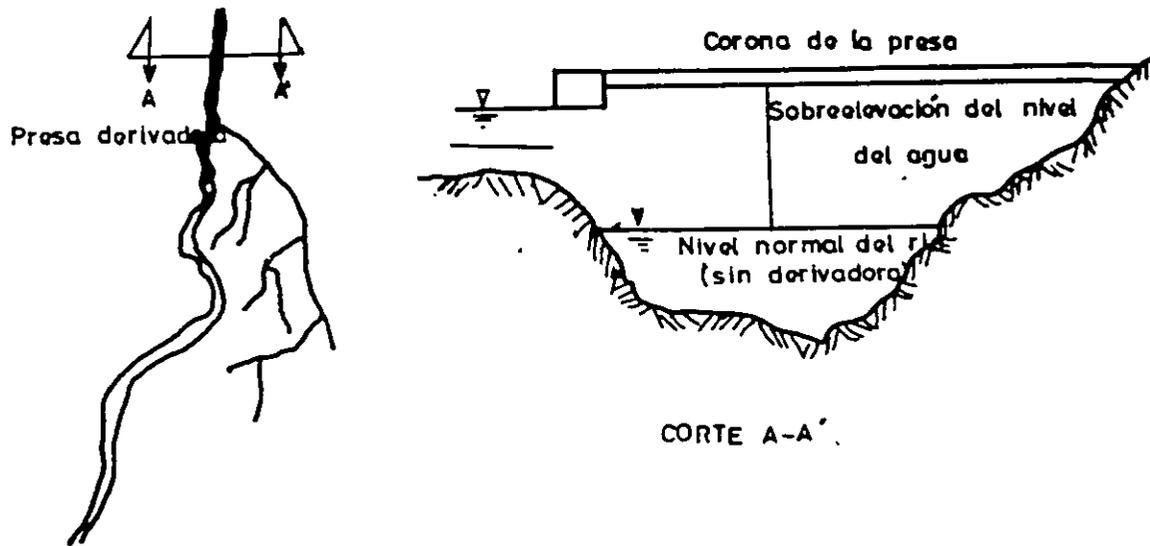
Planta y vista de una presa derivadora (esquemática).
